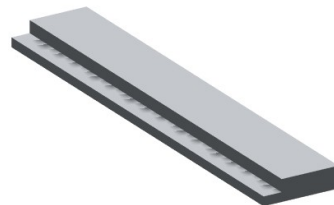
Isometri Model *Redesign Half Slab* Tipe 1A dan 1C dengan Tebal 350 cm
